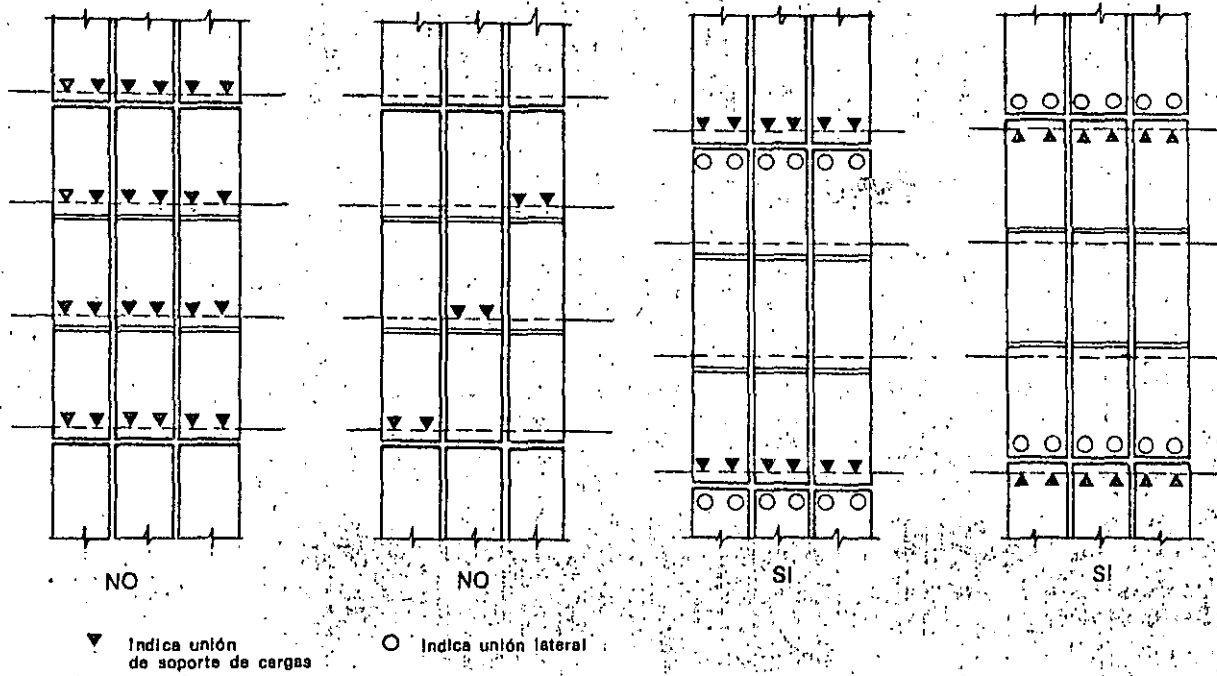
ELEMENTOS PREFABRICADOS UTILIZADOS COMO ENCOFRADO EN MURO HUECO
